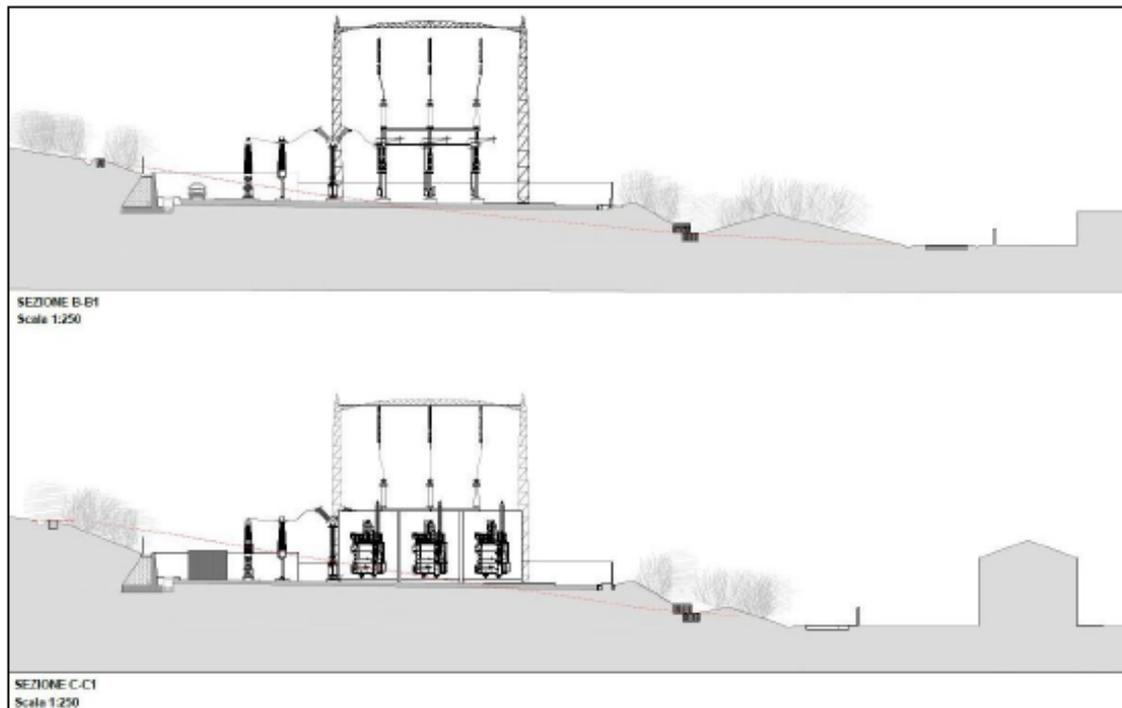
Opere di connessione alla Stazione TERNA: sezioni trasversale
